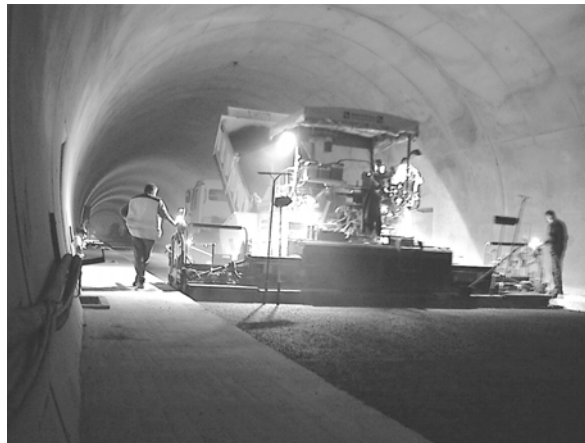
Aufbringen der bituminösen Fahrbahn-decke im Tunnel
